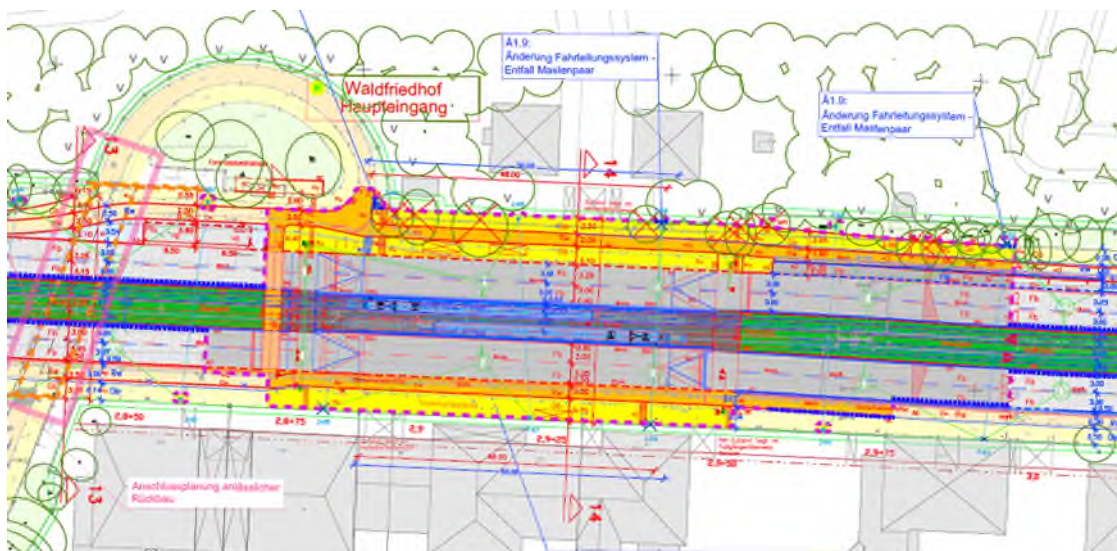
Haltestelle Waldfriedhof Haupteingang, Auszug planfestgestellte Unterlage 03.08B
